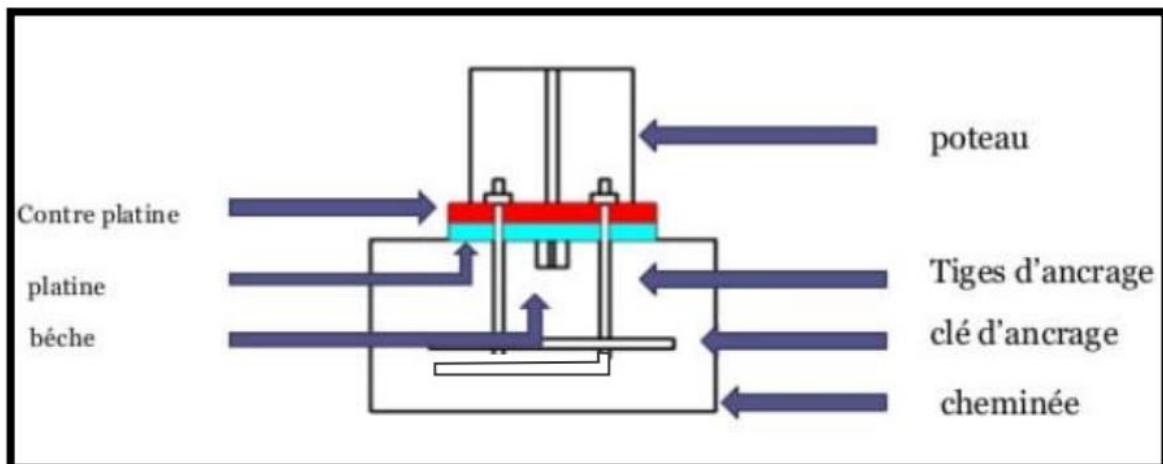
détail d'accrochage de poteau métallique et la semelle en béton
